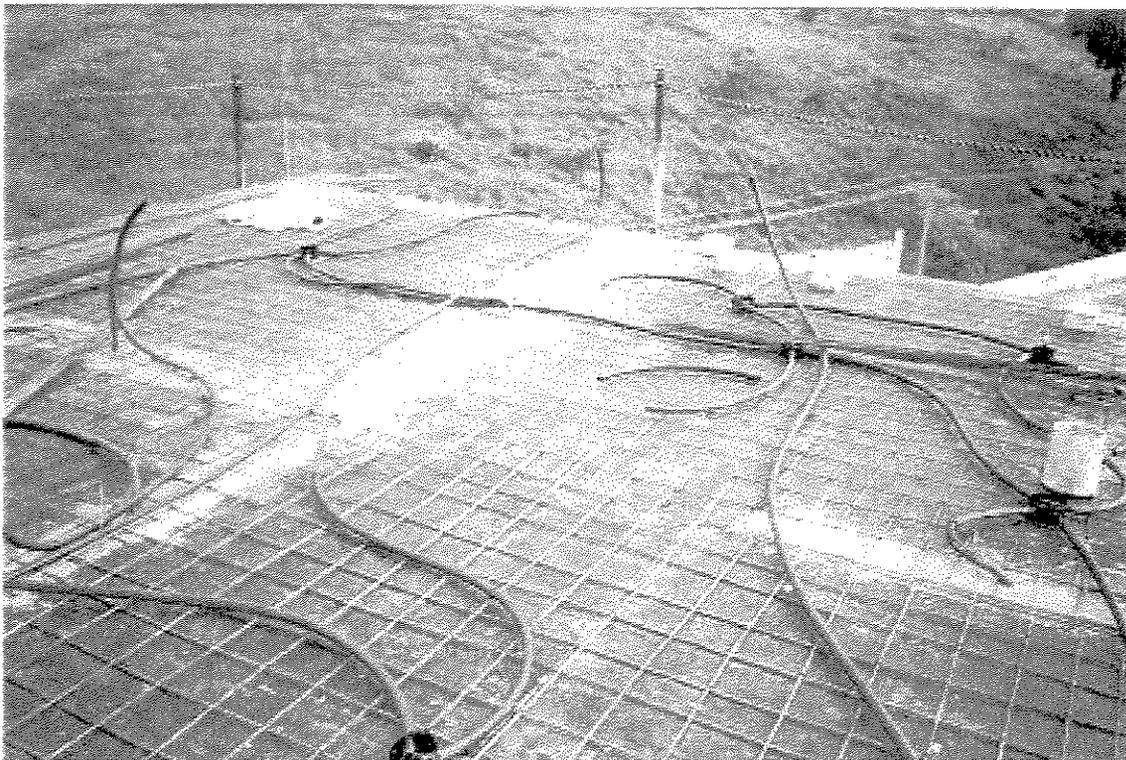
Fôrma, Armação e Tubulação Elétrica da Laje do Pav. Tipo
